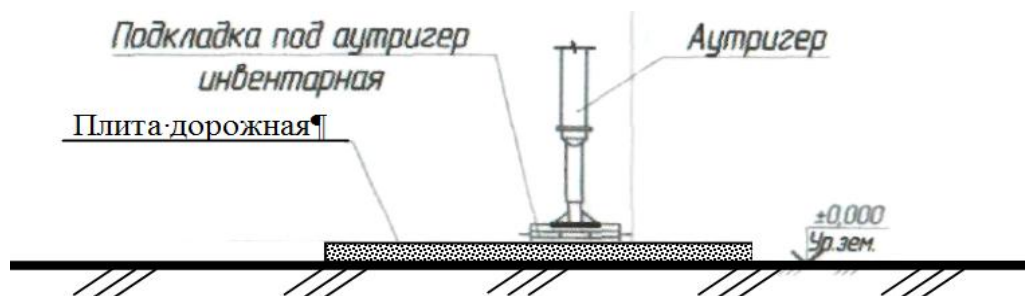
Схема установки выдвигных опор автокрана или крана на спецшасси
